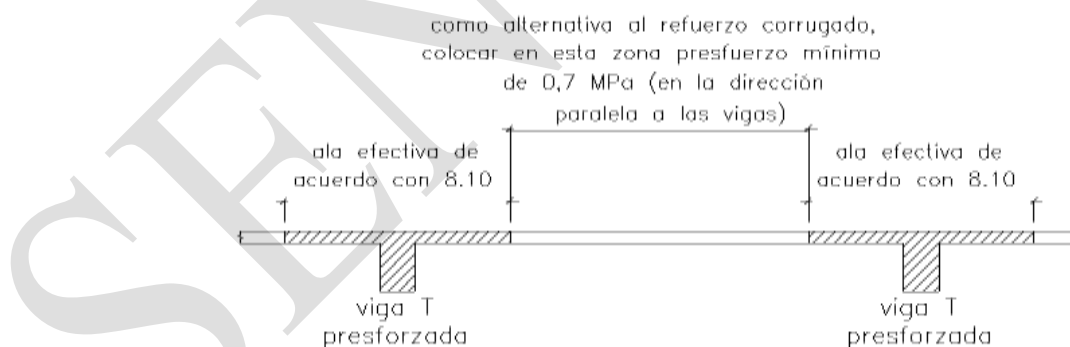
Acero de preesfuerzo utilizado como refuerzo de retracción y temperatura en una losa.
